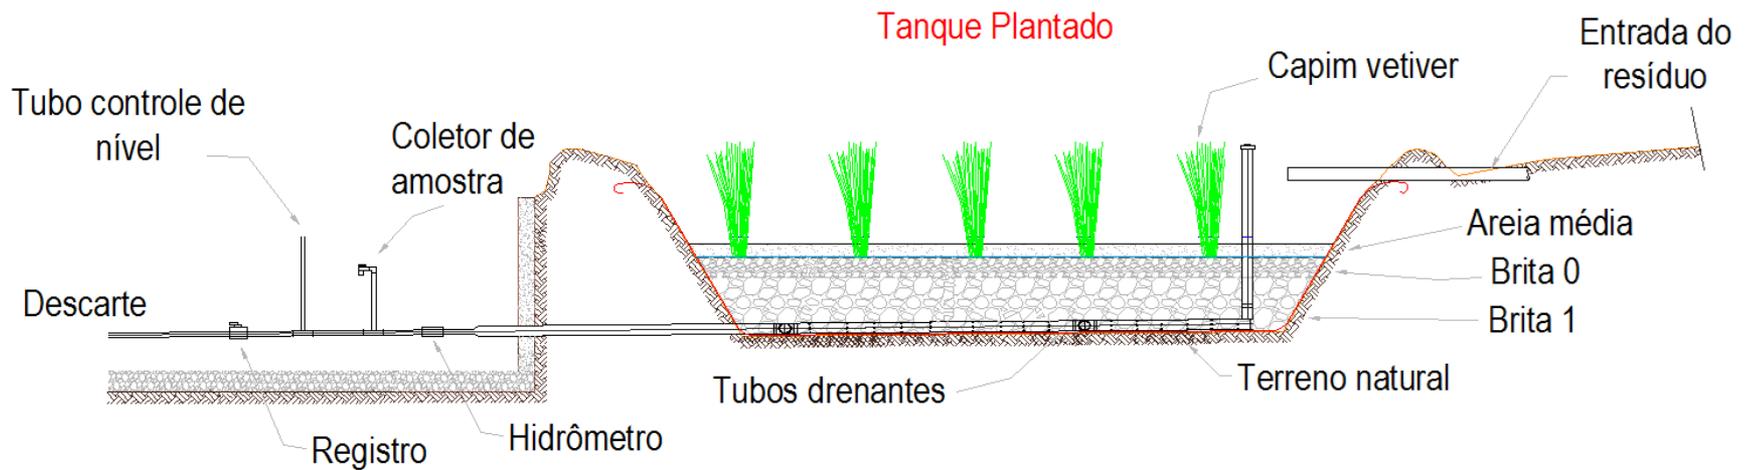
Corte transversal (sem escala) do sistema implantado.
